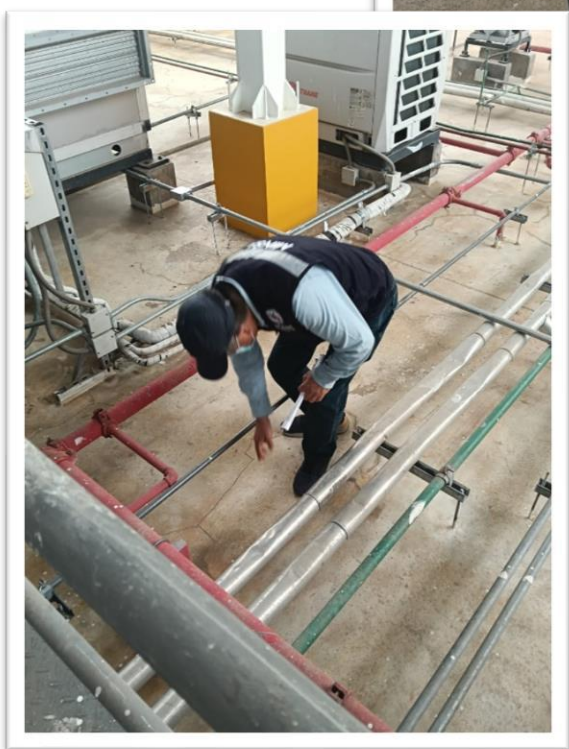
En el último nivel la losa aligerada de concreto presenta grietas debido a que no se encuentran impermeabilizado.
